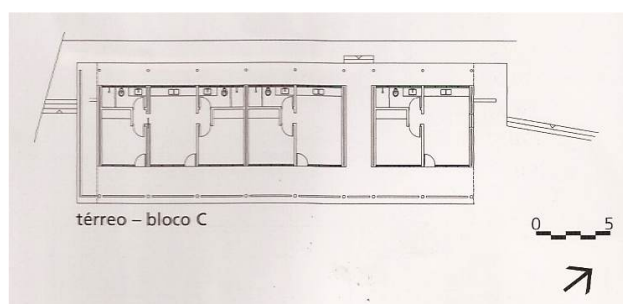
Pousada Pedra Grande - Planta do pav. Inferior
